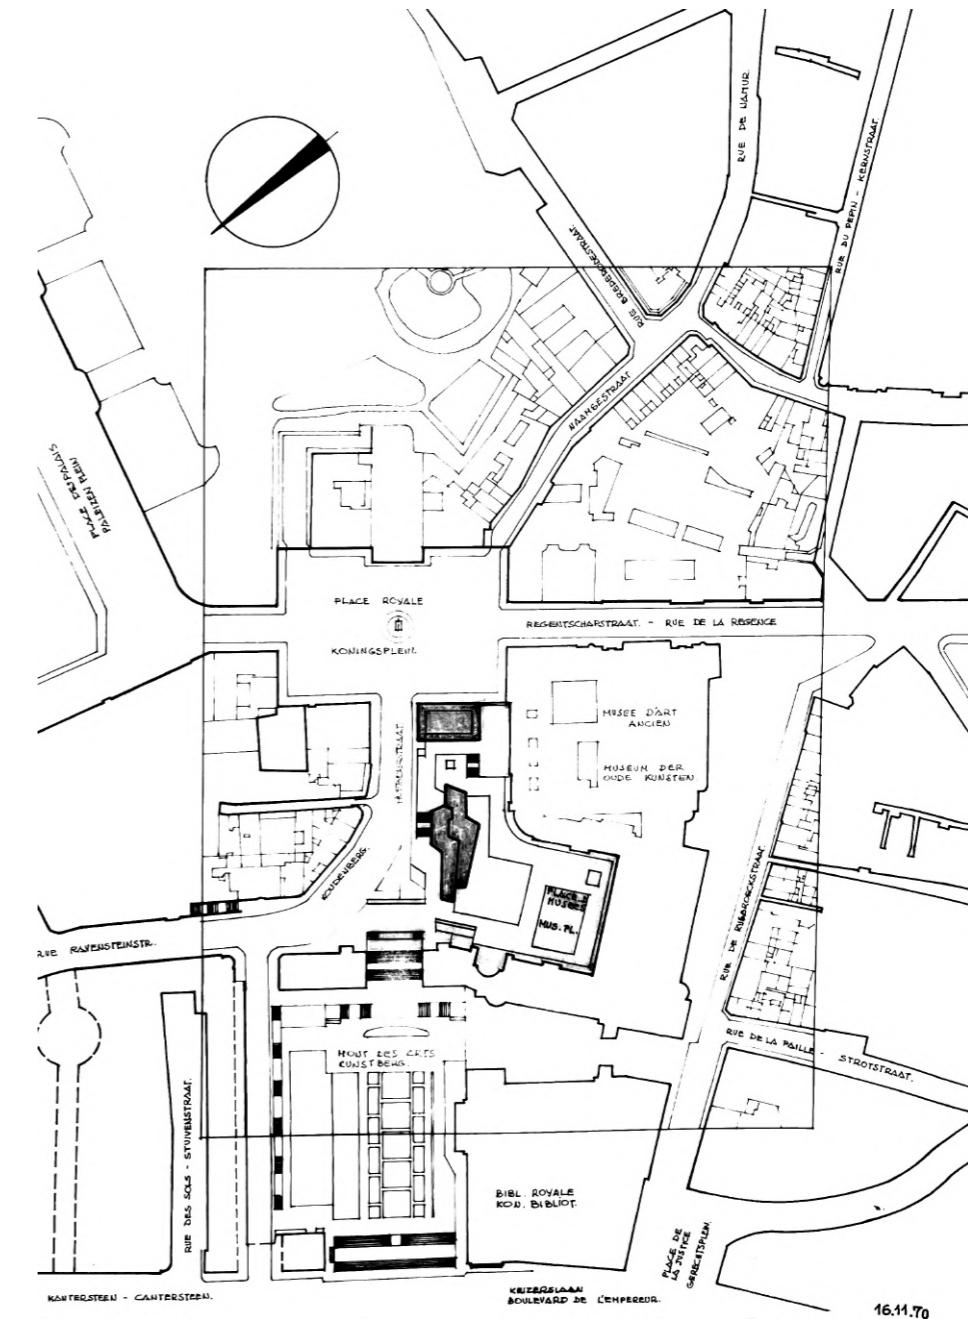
Plan de situation, 6^{ème} esquisse v3.
